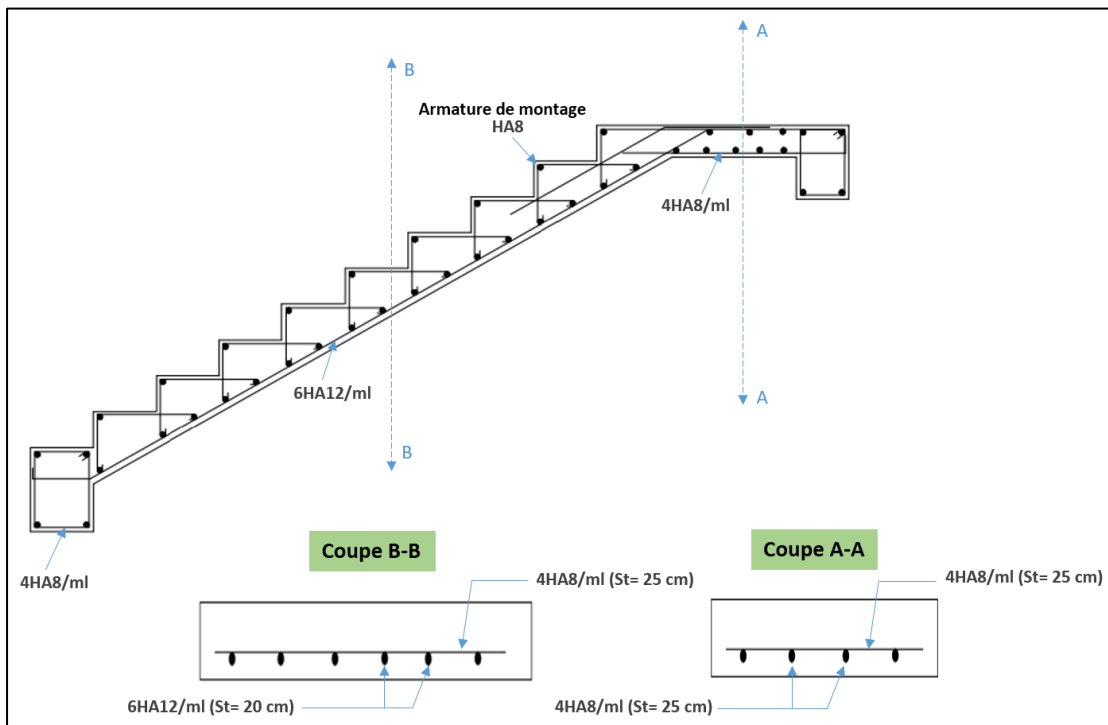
Ferrailage de l'escalier droit à deux volées et un palier de repos
